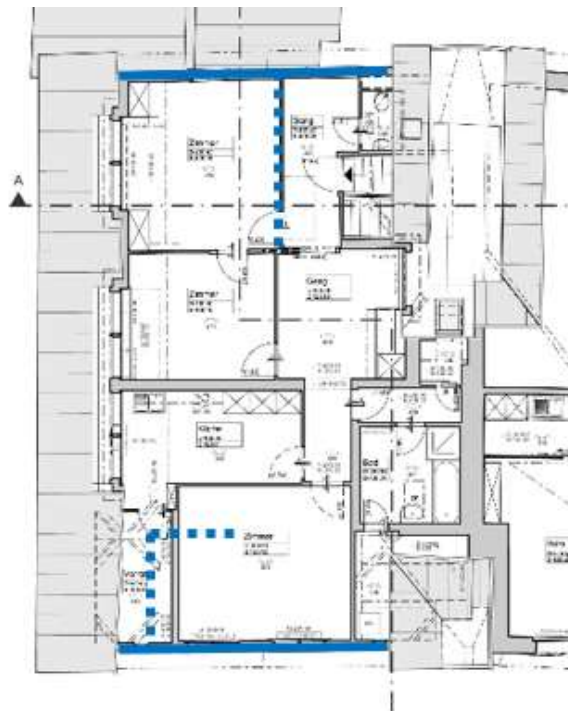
Grundriss 1 Dachgeschoss. Hier sind aktuell kaum verlässliche Aussagen zum einstigen Grundriss möglich.
